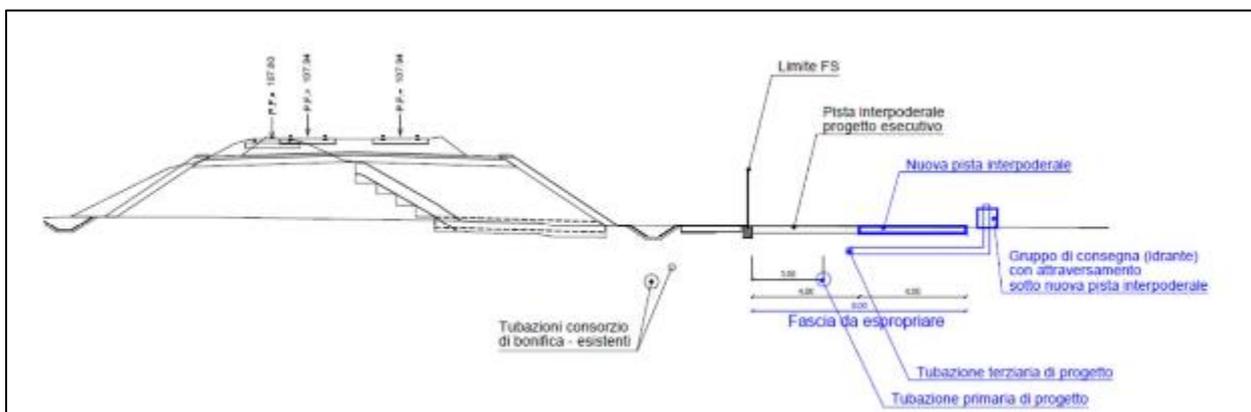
Schema localizzazione condotte, rispetto al progetto
